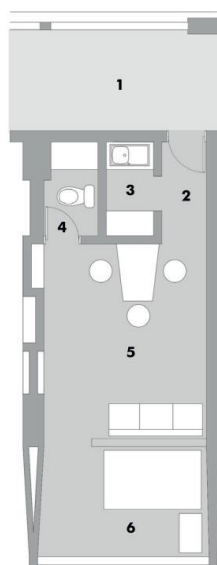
Planta baixa célula Quitinete (Q) Japurá.
